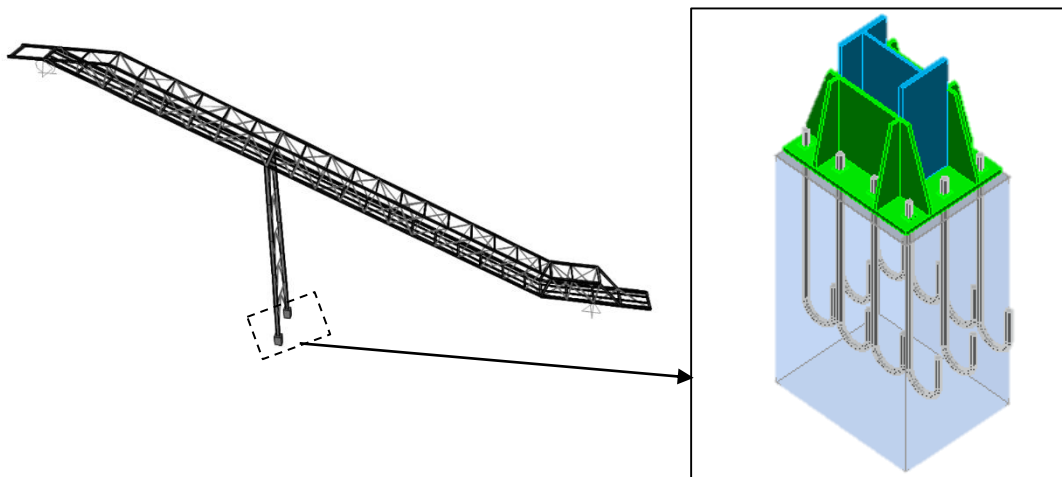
Pormenor da Ligação do Pilar ao Plinto para a combinação 2
